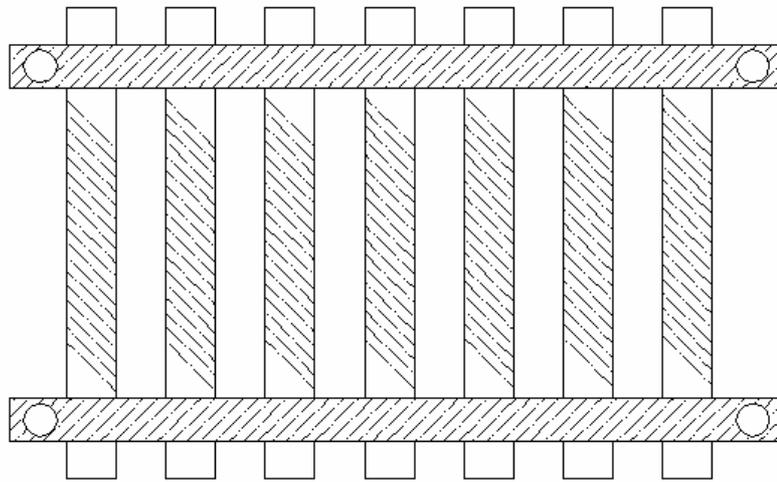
Vista lateral Entibación de madera Semi-Cuajada.
